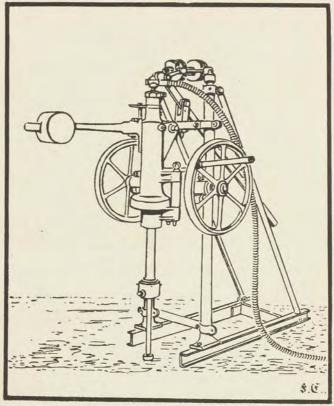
Maschine zum Bohren von Sprenglöchern.
